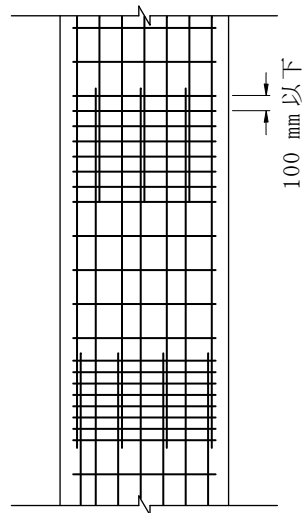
重ね継手部の帯鉄筋、中間帯鉄筋及びフープ鉄筋の間隔
